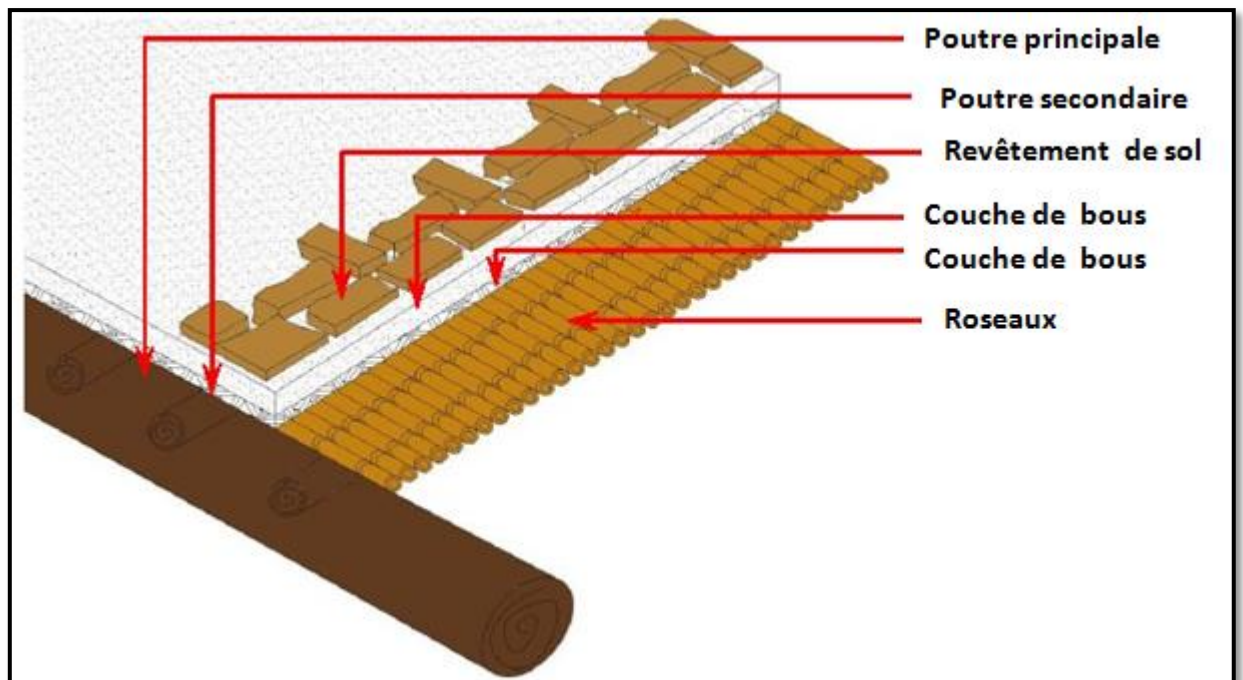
schéma des planches en 3d . (Source par l'auteur)
